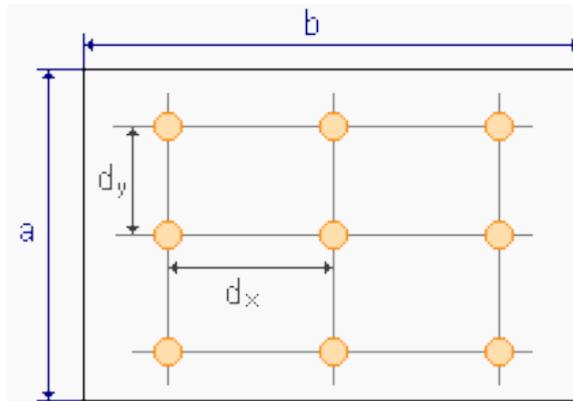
Emplazamiento de luminarias en local de planta rectangular.
